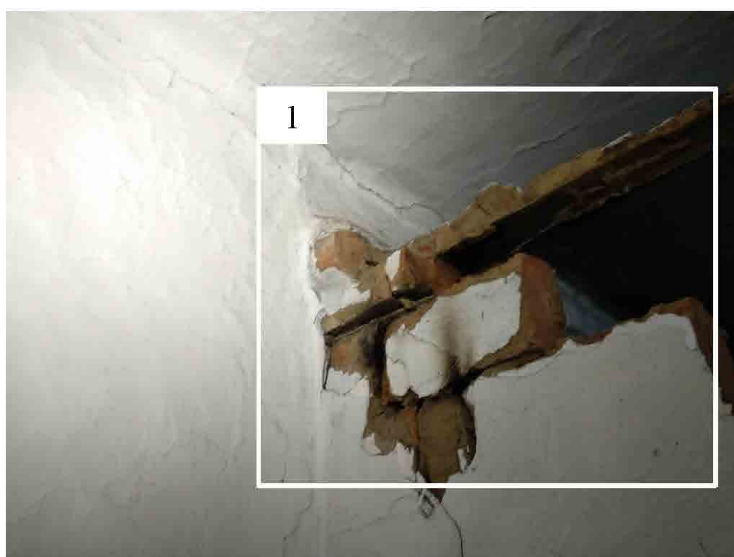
Печь. Дефекты: 1 – разрушение кладки.
